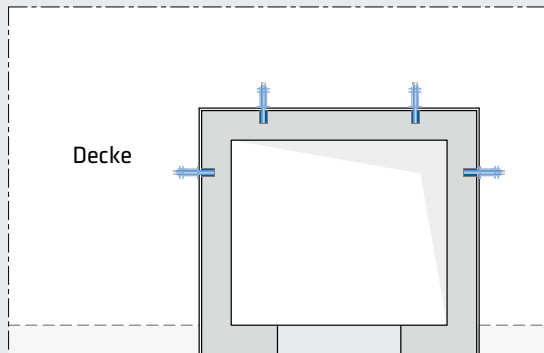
Auflagerung von Decken auf Wände (z. B. Aufzugsschachtwände)
